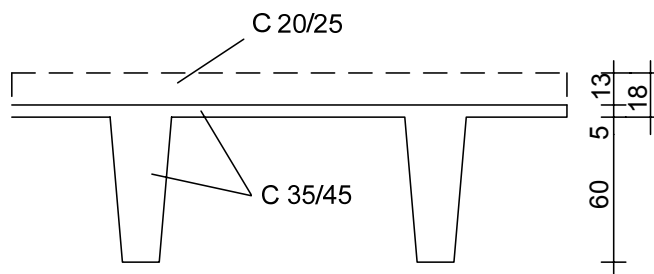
Variante 1 (Plattenbalken mit Ortbetonerfüllung)
